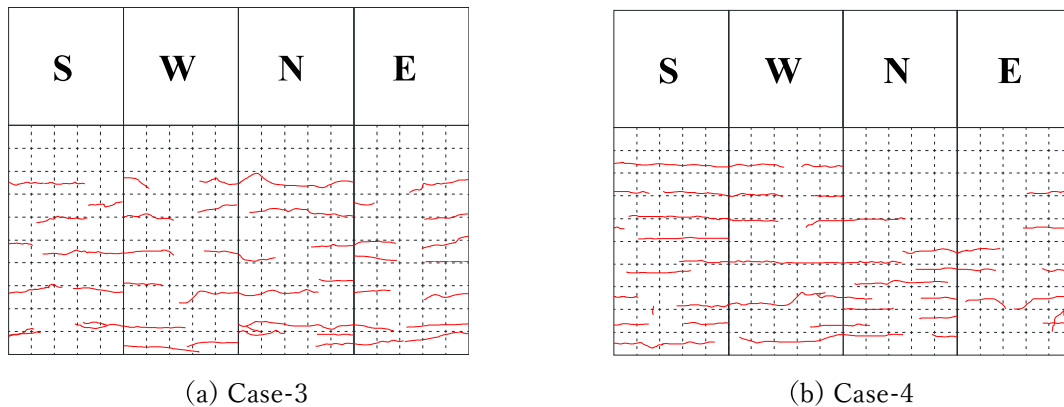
2.0%ドリフト(32mm)時の供試体ひび割れ進展状況
